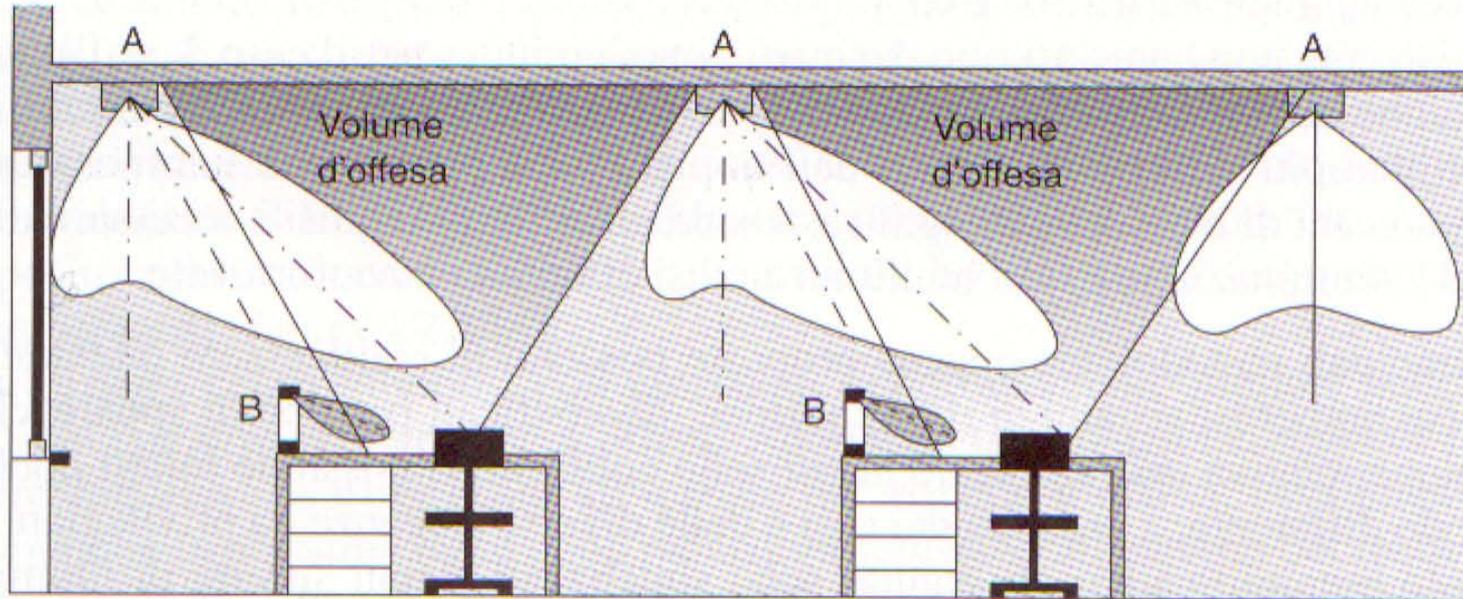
Impianto base integrato con apparecchi dislocati sui singoli piani di lavoro.
